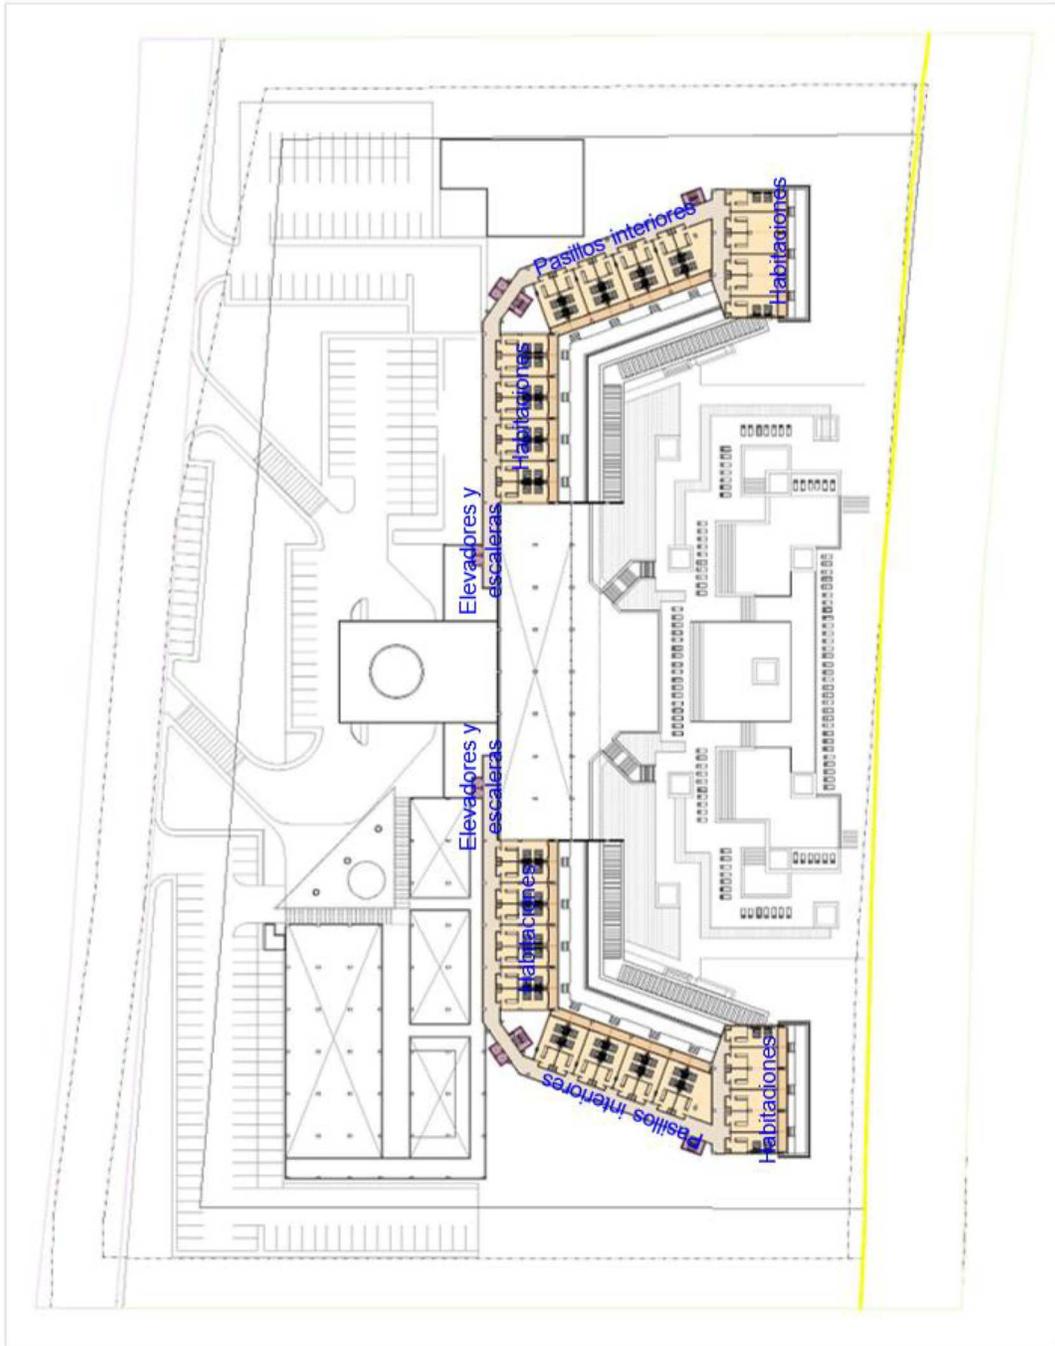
Obras del proyecto en niveles 5 al 11 en donde se ubican únicamente habitaciones, pasillos interiores, elevadores y escaleras.
